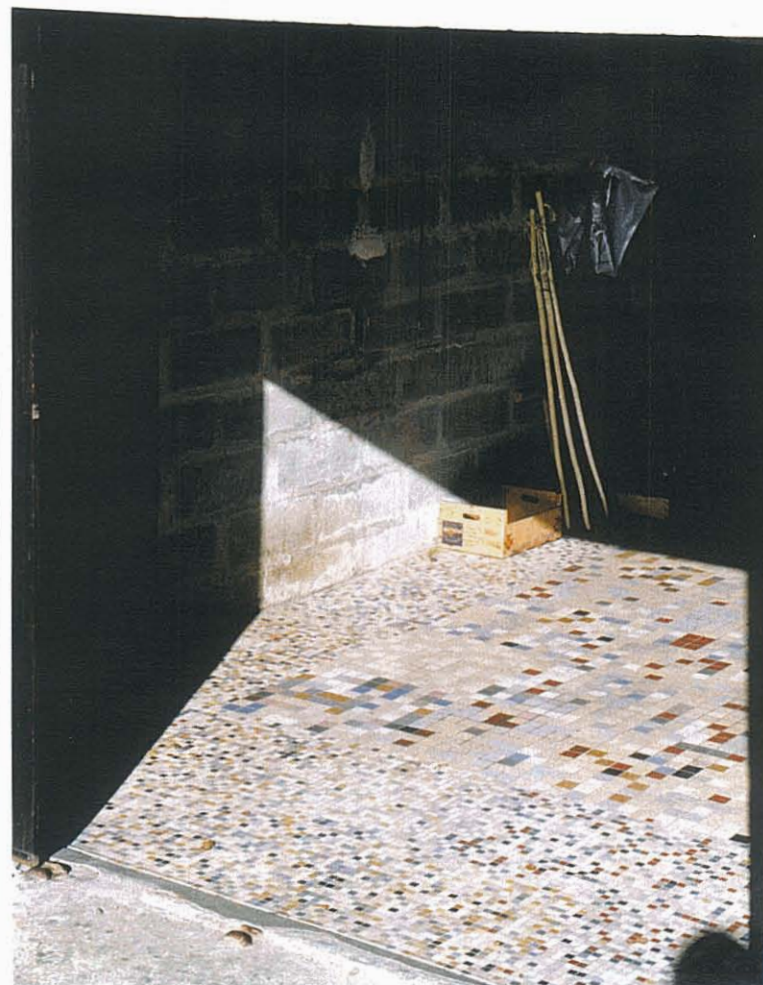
Ecartements des joints d'agglos sur façade N-W.
